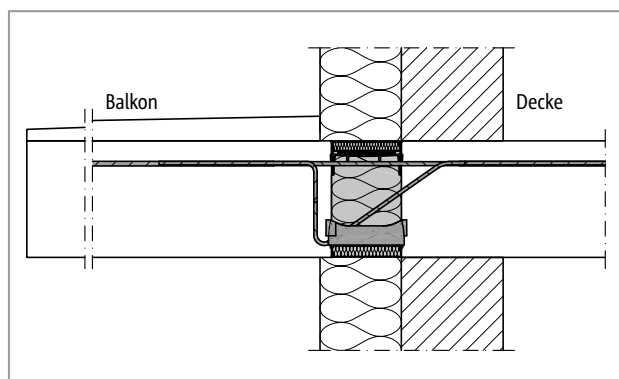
Schöck Isokorb® XT Typ K-...-REI120: Verwendung als Brandriegel in Verbindung mit einer Stahlbetonbalkonplatte
